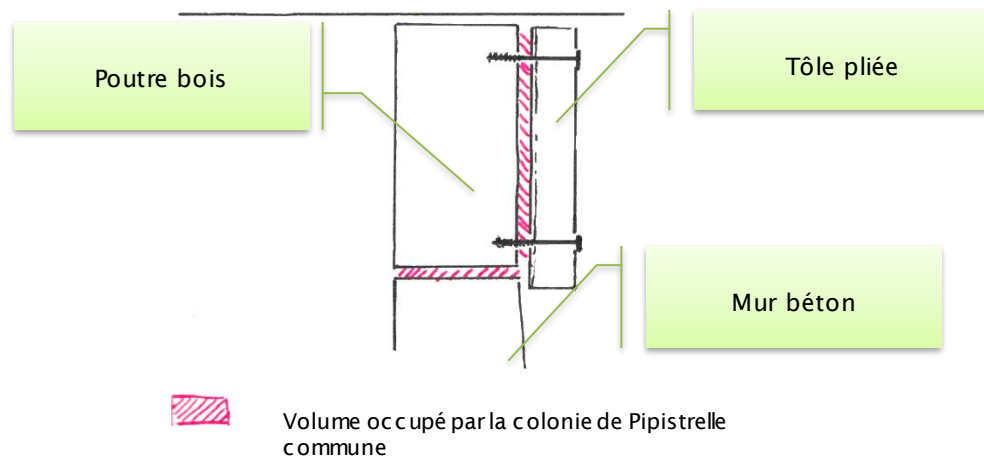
Structure de la comiche béton/bois/tôle accueillant les Pipistrelles dans le bâtiment B-8.1
